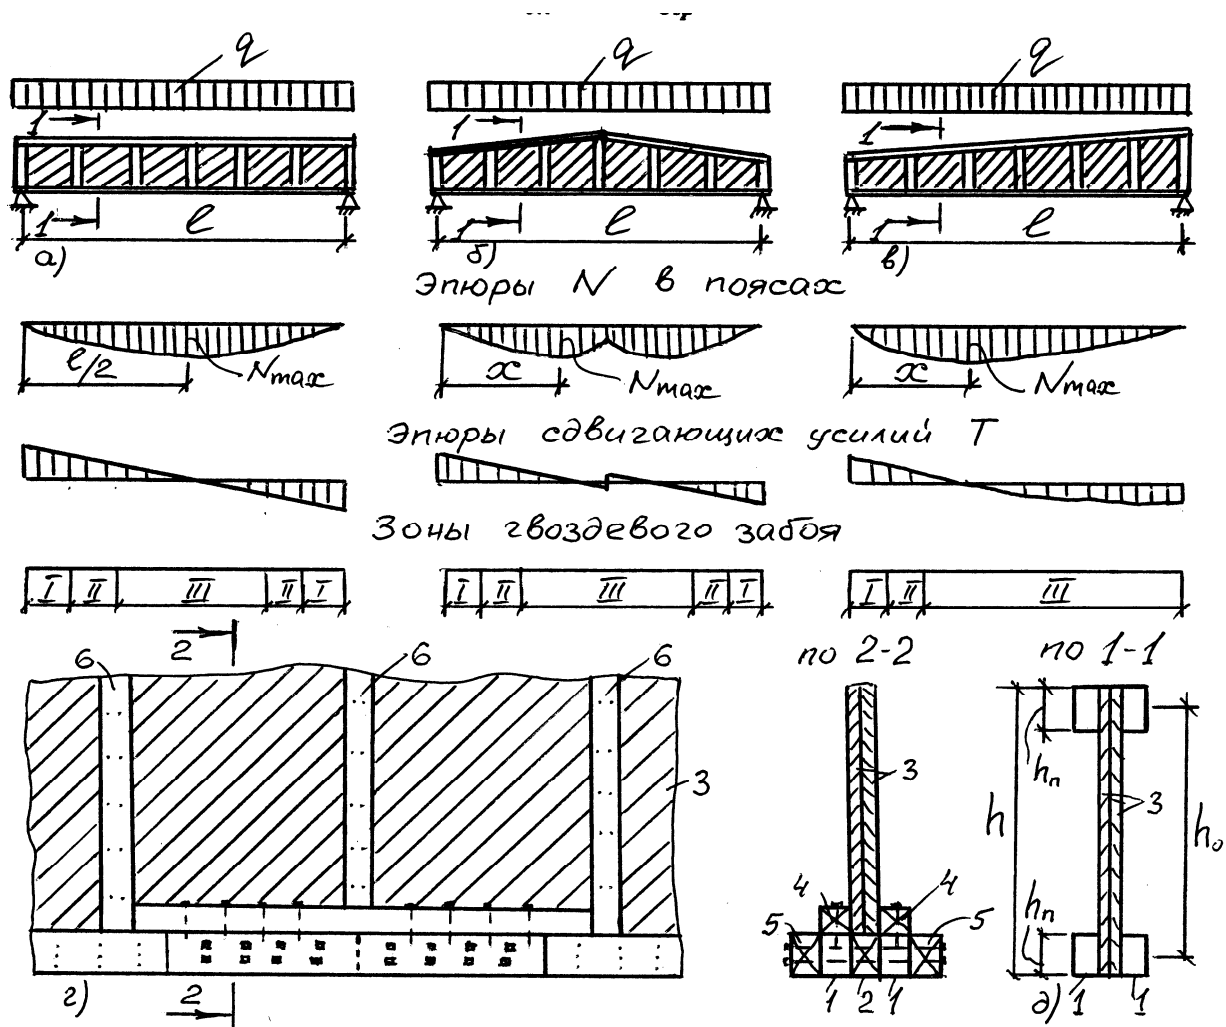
Балки двотаврового перерізу з перехресною стінкою:
